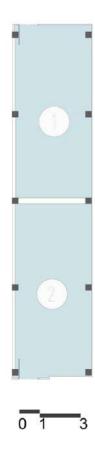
Planta 1 Bloque 41. Fuente: Equipo de diagnóstico.
